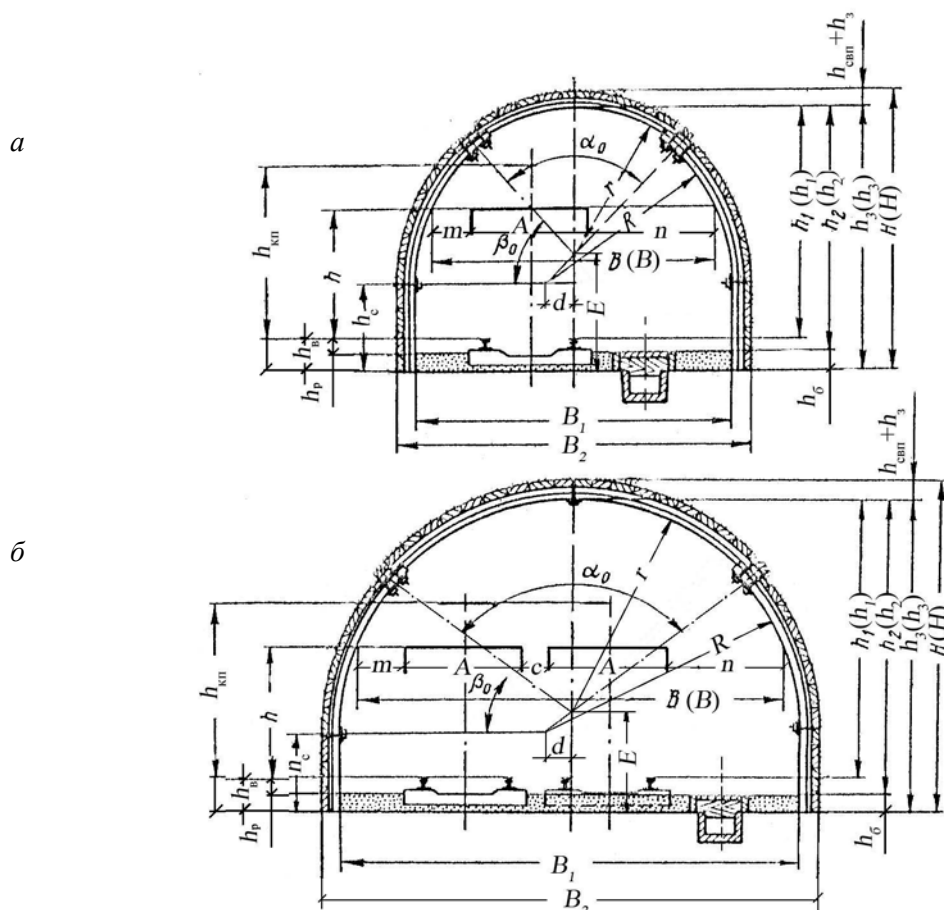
Поперечные сечения выработок прямоугольно-сводчатой формы с арочной трёхзвенной податливой крепью (КМП-А3) из специального взаимозаменяемого профиля (СВП):
